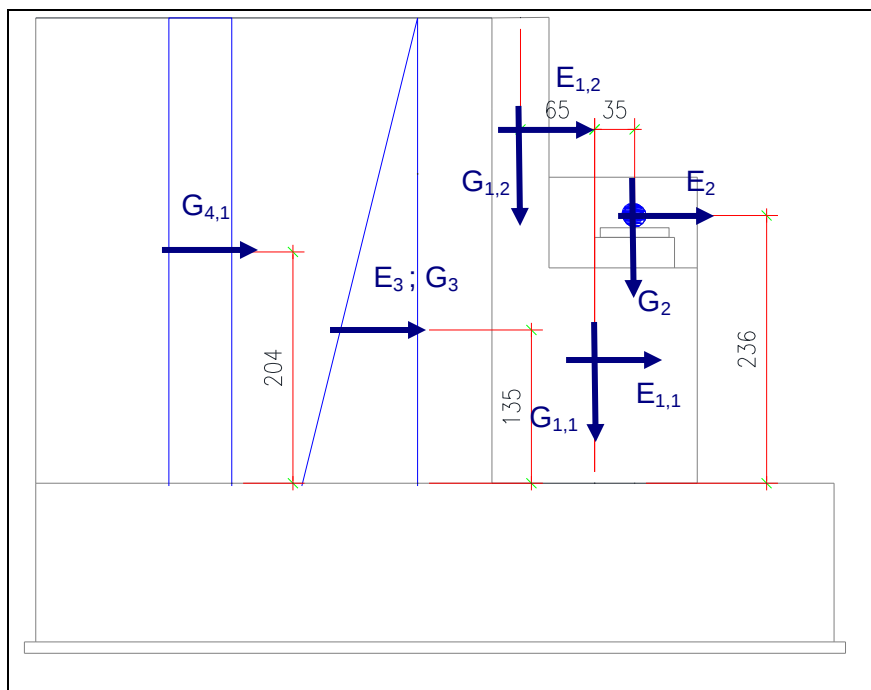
Spalla A - Centri di applicazione azioni per muro in elevazione
